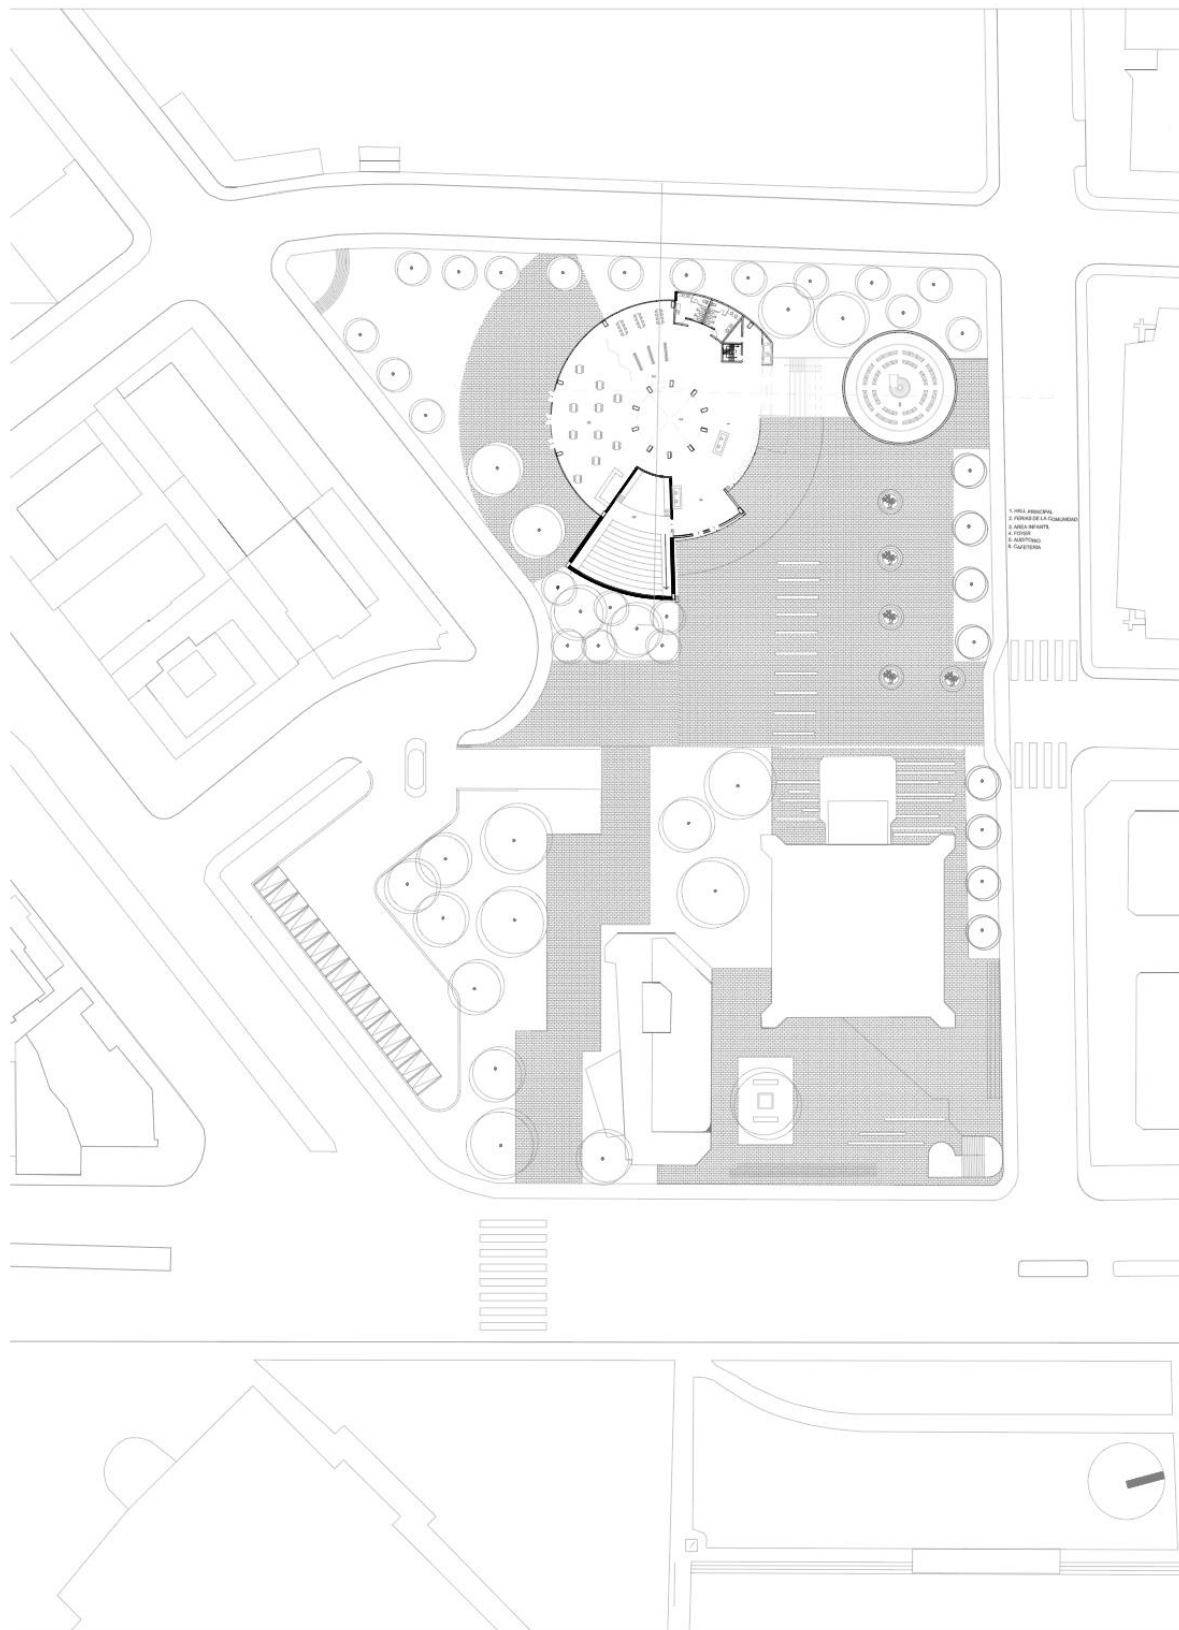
Planimetría: Implantación Planta baja (N 0,00)
